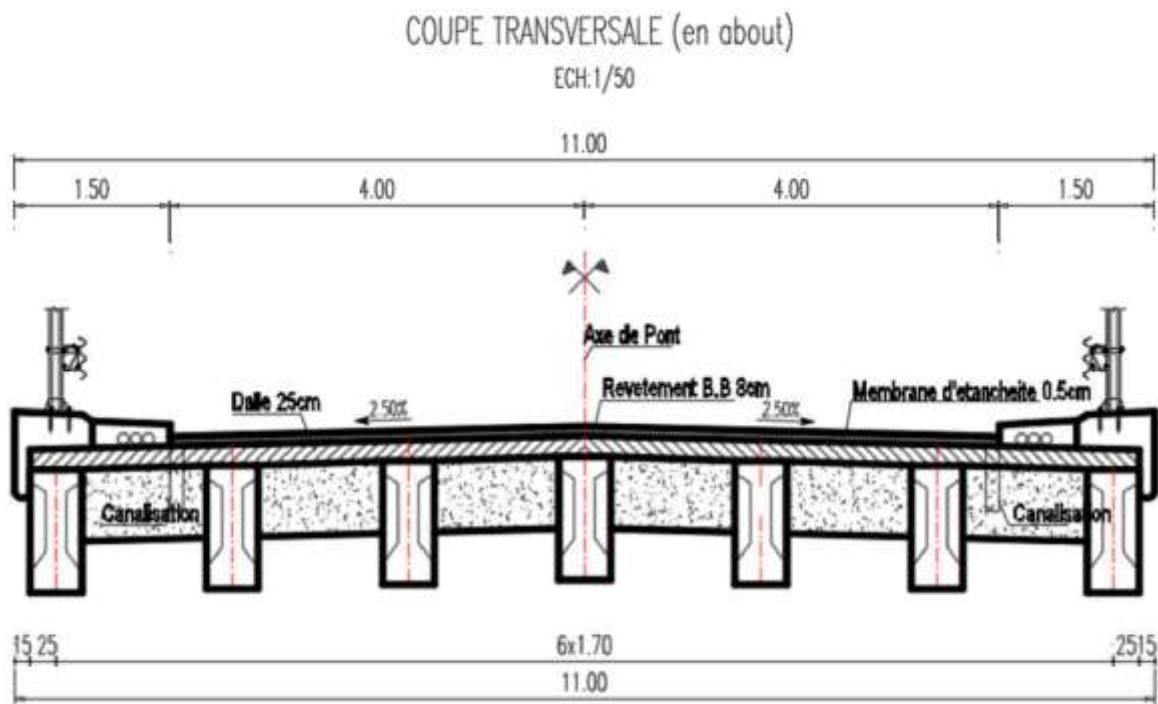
Coupe transversale en About de la Variante de Poutre en Béton Armé
